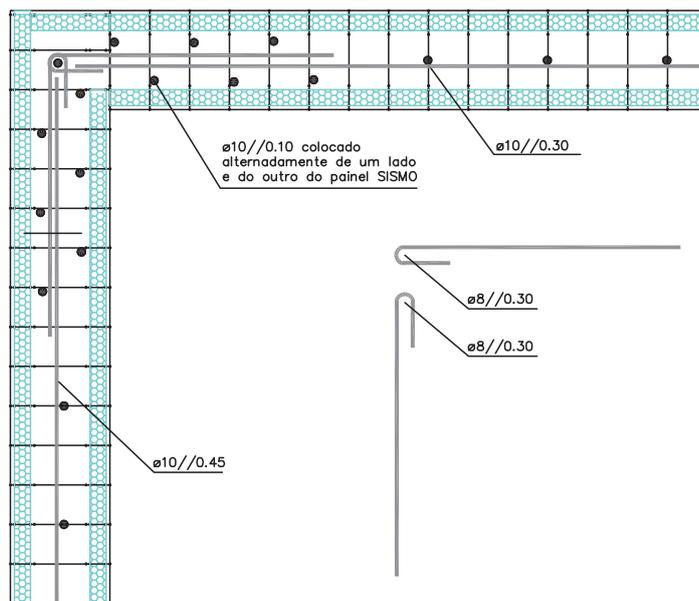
Pormenores estruturais SISMO® (Fonte, [Technology, 2013](#))
